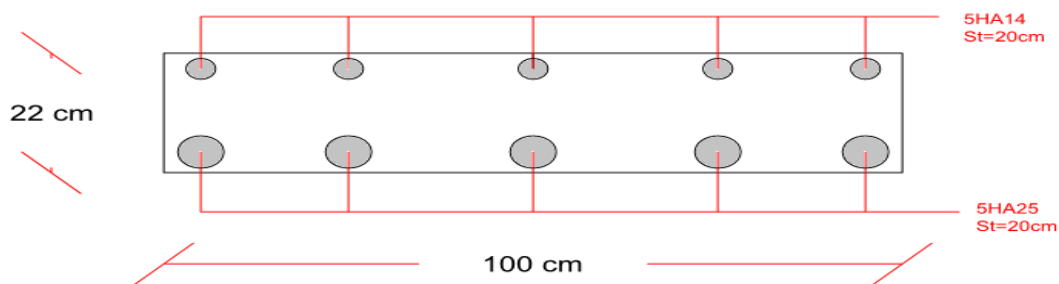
Schéma représente le ferrailage transversale de l'hourdis
